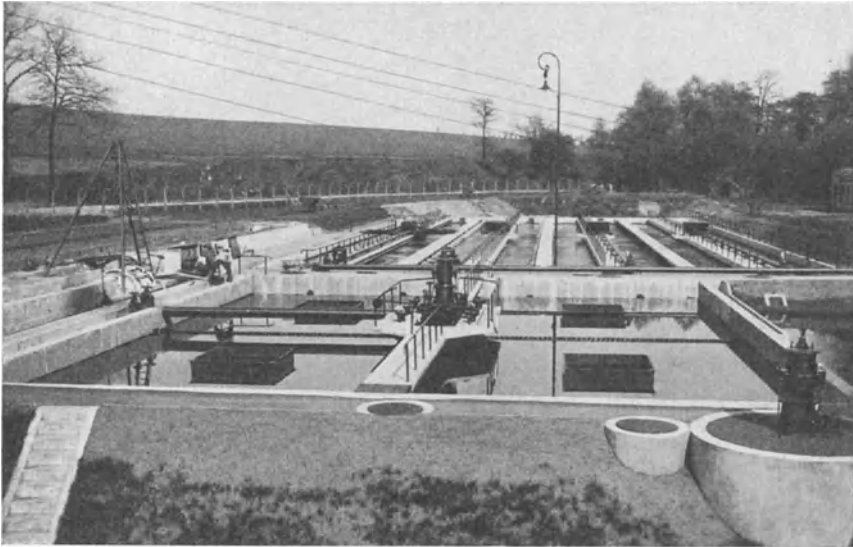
Ansicht der Anlage in Essen-Rellinghausen.
